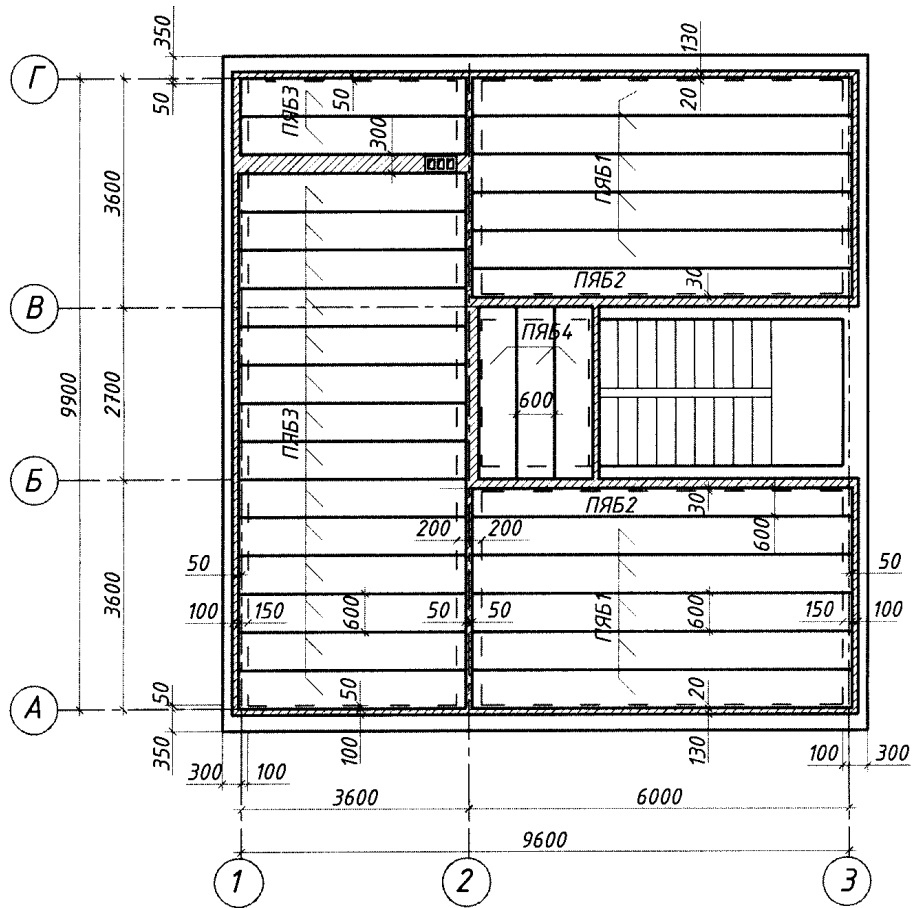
Пример выполнения плана перекрытия с применением плит из ячеистого бетона
